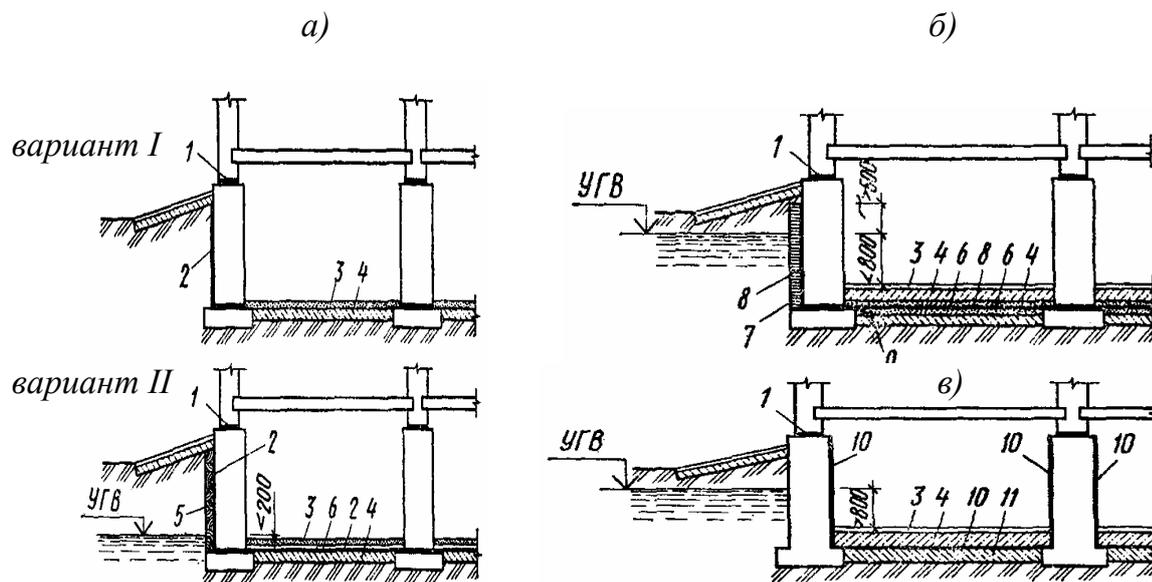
Гидроизоляция подвала: а – обмазочная; б – облицовочная; в – оклеечная; 1 – гидроизоляция стен от грунтовой сырости; 2 – обмазка битумом за два раза; 3 – влагостойкий пол; 4 – бетон; 5 – глиняный замок; б – цементная стяжка; 7 – защитная кирпичная стенка; 8 – гидроизоляция из рулонных материалов, наклеенных на мастике; 9 – осадочный шов с компенсаторной петлей гидроизоляционного ковра; 10 – металлический кессон; 11 – железобетонная плита
